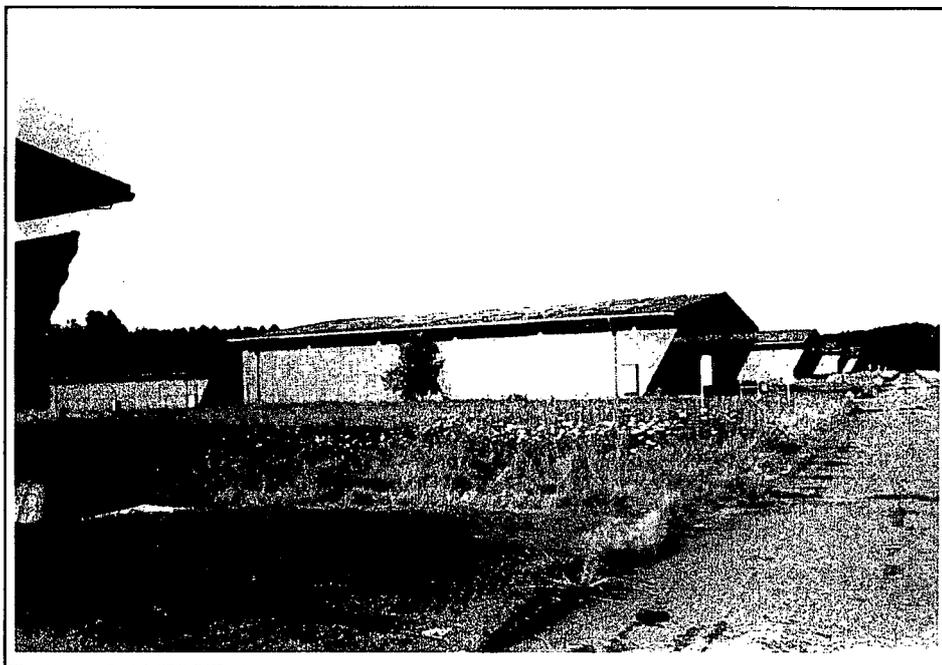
Bereich Benzinabscheider zwischen der Abstellhalle (2) und dem Lagerhaus für Geräte (21)
